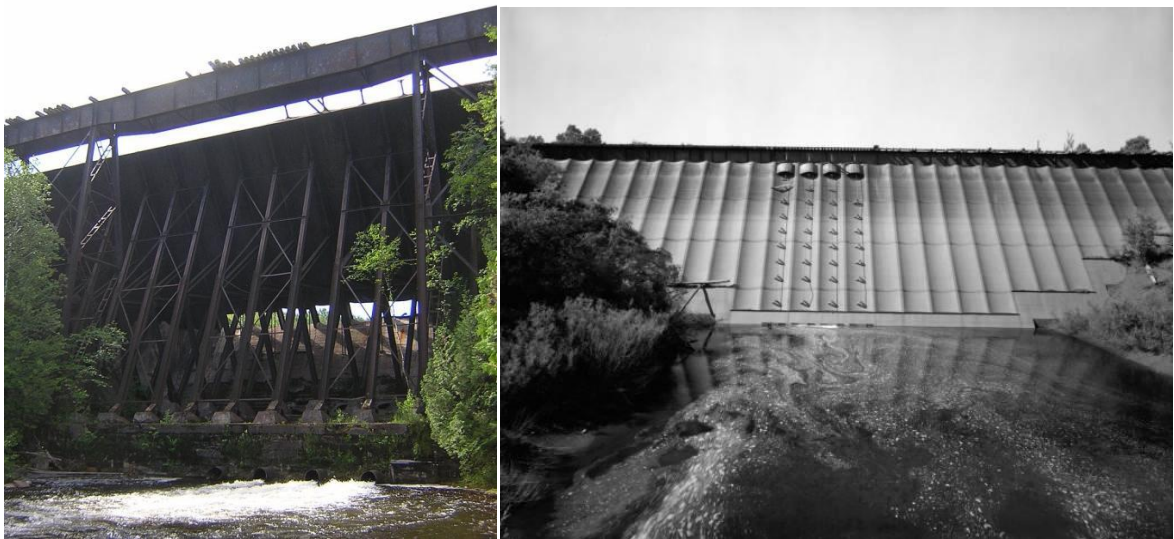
Vista de jusante e de montante da barragem Redridge Steel Dam (EUA, 1901) [81]
